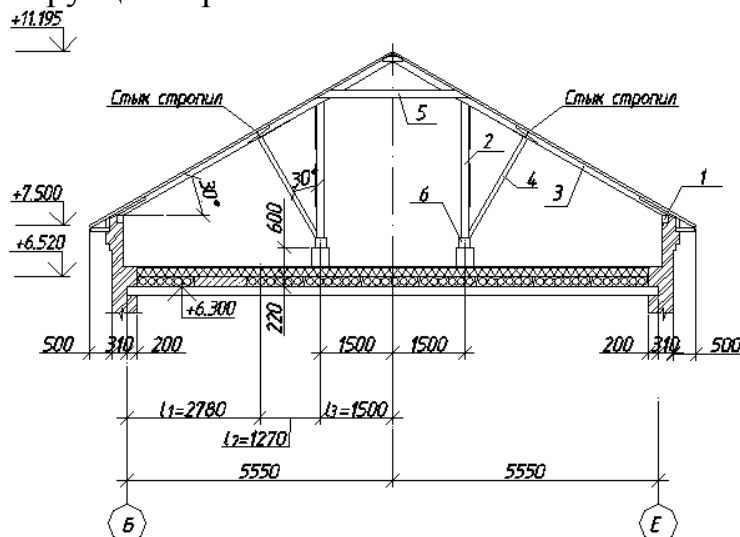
Конструктивная схема: 1 – мауэрлат; 2 – стойка; 3 – стропила; 4 – подкос; 5 – ригель; 6 – лежень
